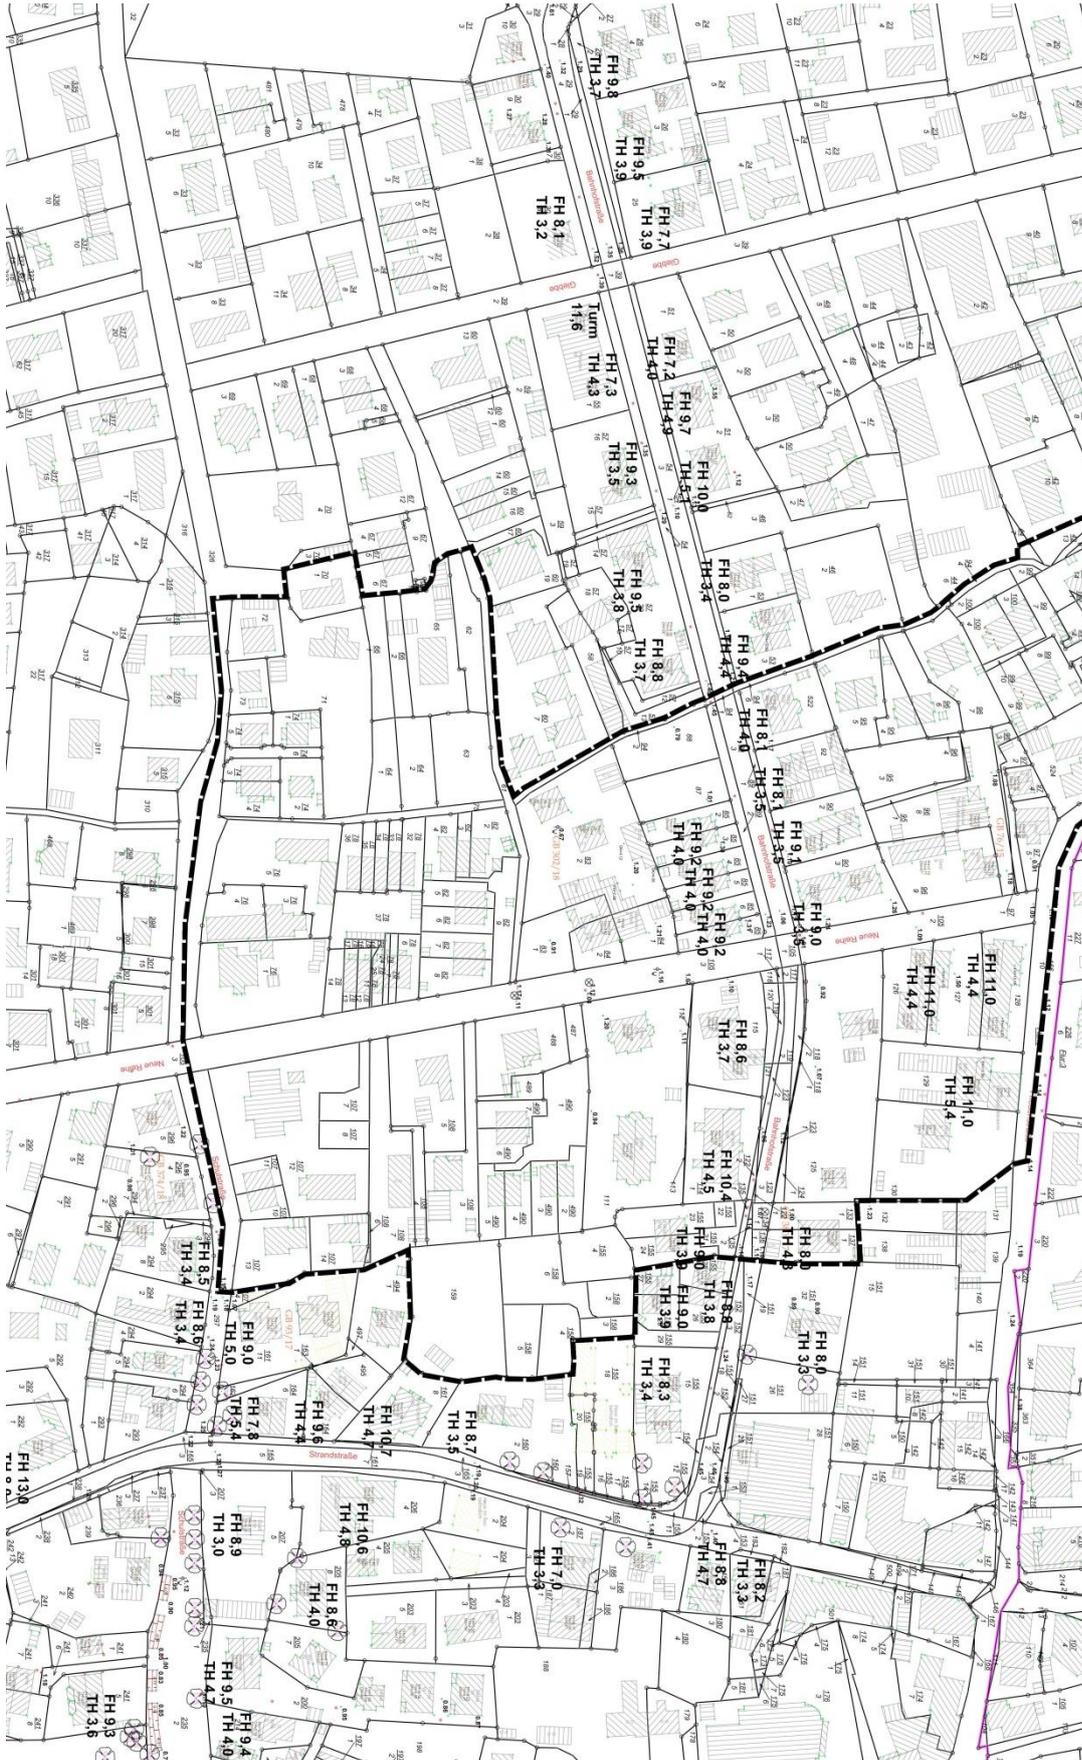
First- und Traufhöhen straßenbildprägender Hauptgebäude über Verkehrsfläche
